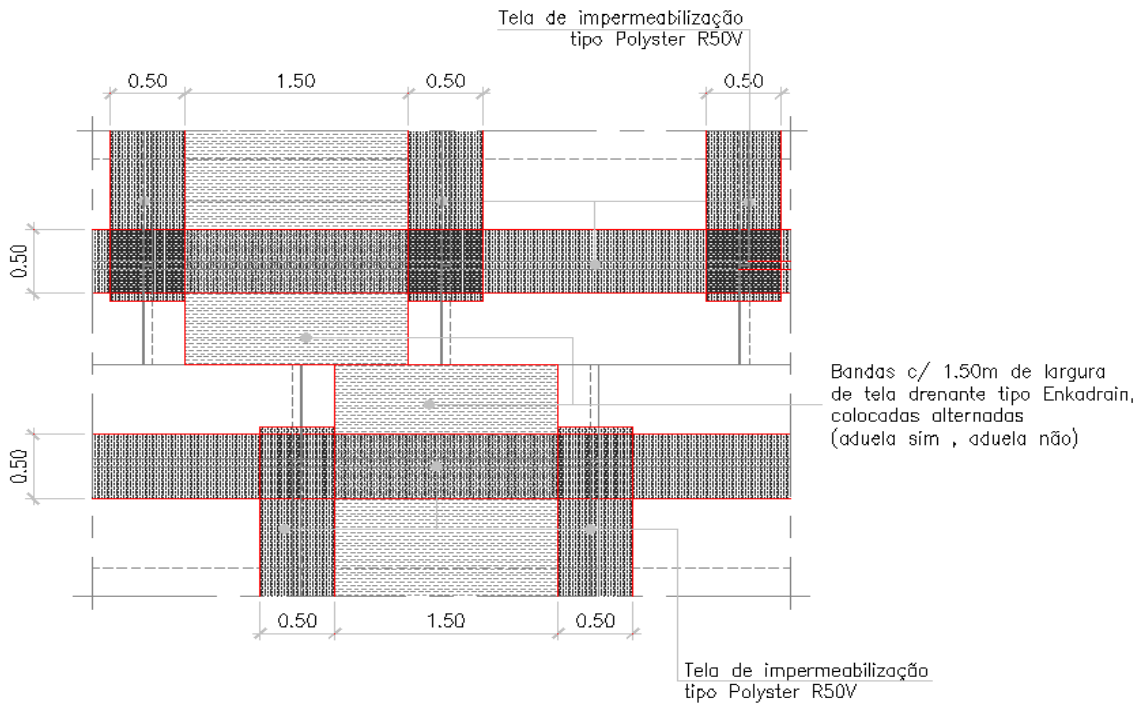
Esquema da impermeabilização das aduelas - Vista de planta (COBA *et al.*, 2008)
